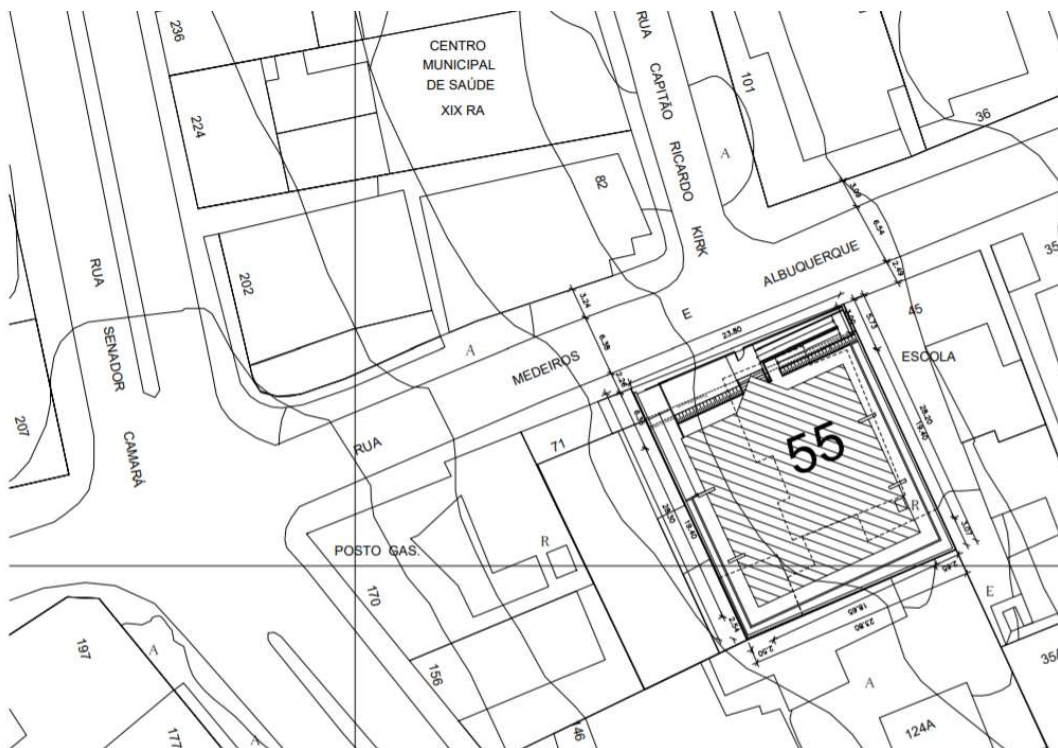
Planta de situação com a área onde será desenvolvido o projeto [Fonte: Desenho Archi5 01- 01-DPSC\_PE\_ARQ-SIT].
